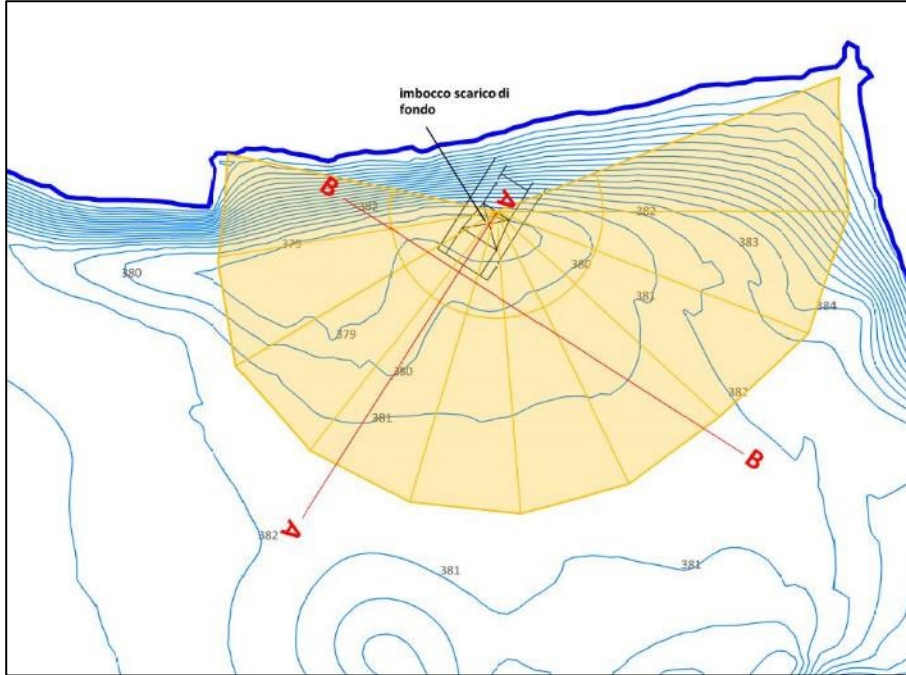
Rappresentazione dell'area di dragaggio e ubicazione delle sezioni rappresentative di scavo in direzione longitudinale (sezione A-A) e trasversale (sezione B-B) rispetto all'imbocco di scarico
